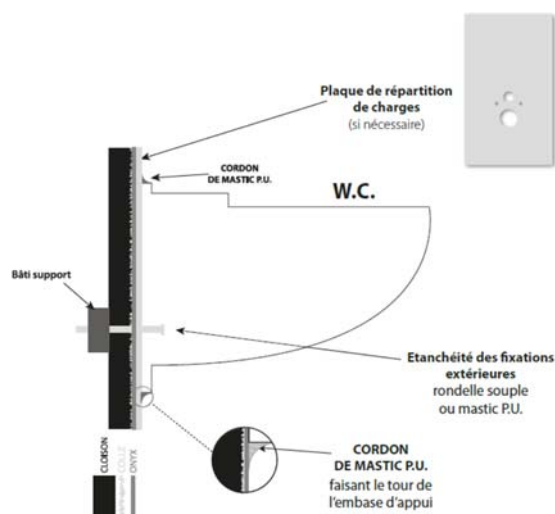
Etanchéité des fixations murales (cuvette WC)
